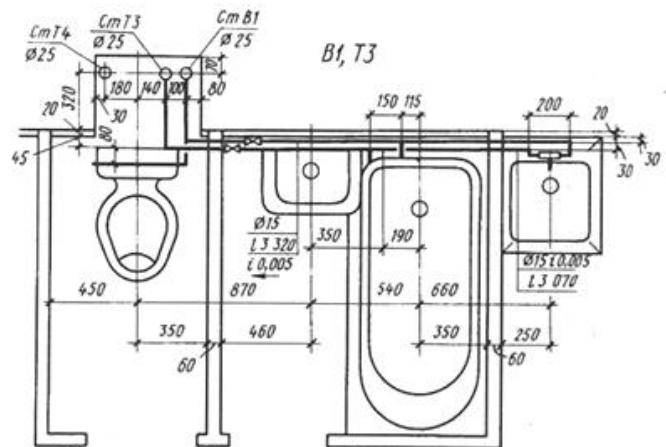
Фрагмент монтажного плана санитарного узла.
